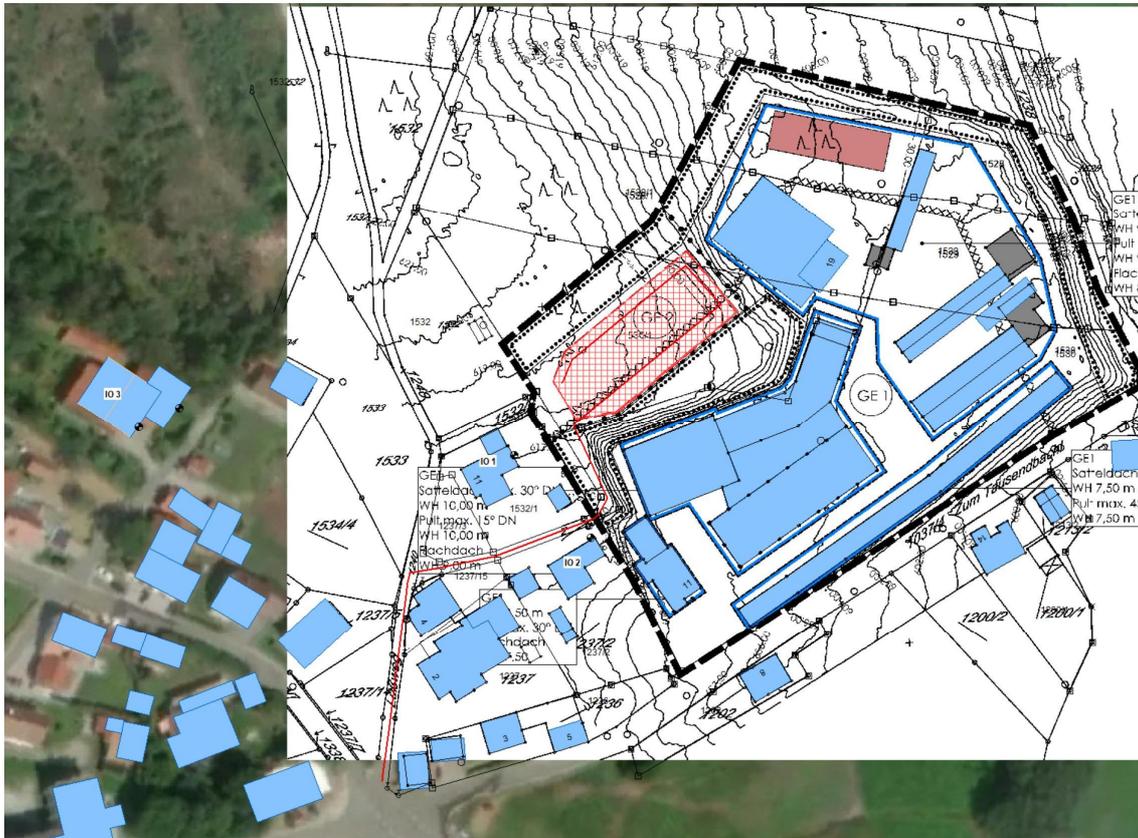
Lageplan mit Kennzeichnung Immissionsorte IO 1 – IO 3
